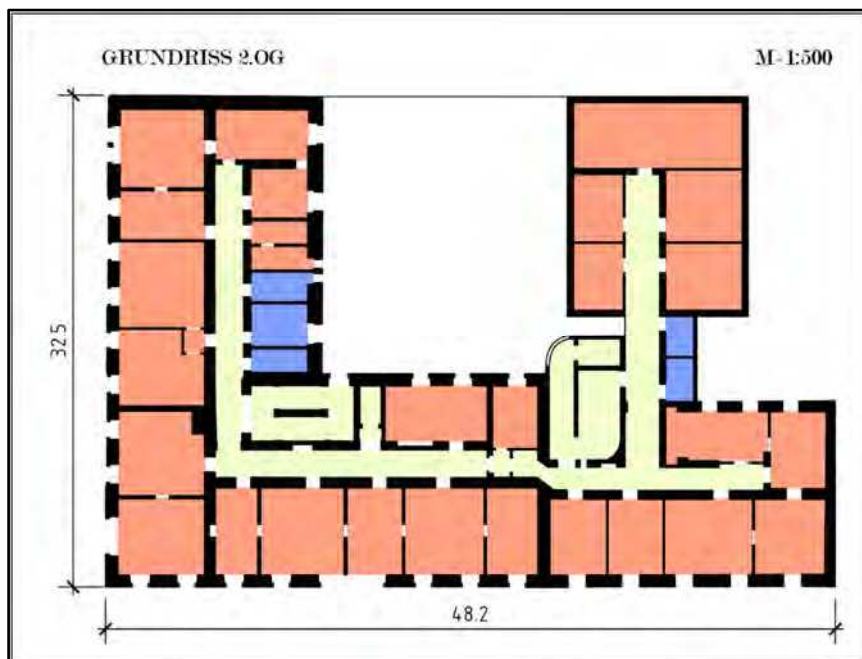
Illustration XLIX: Grundriss 2. Obergeschoss Bezirkshauptmannschaft
